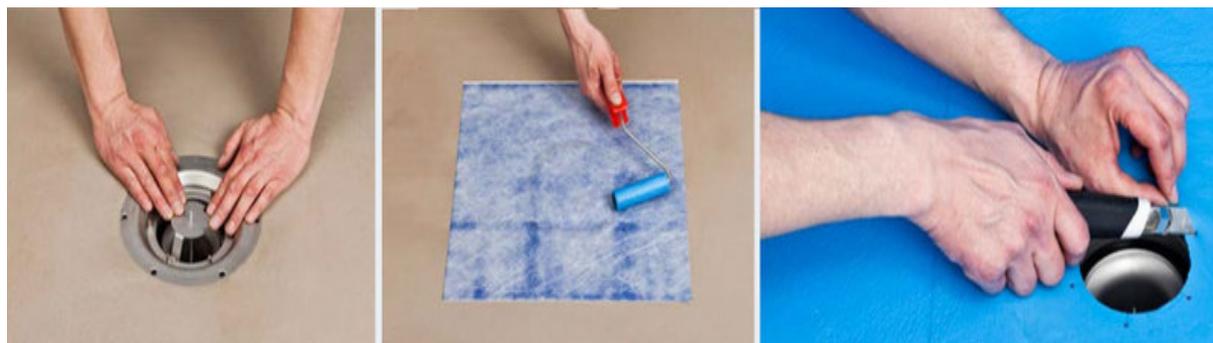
Realizzazione di impermeabilizzazione attorno a un foro di un pavimento
